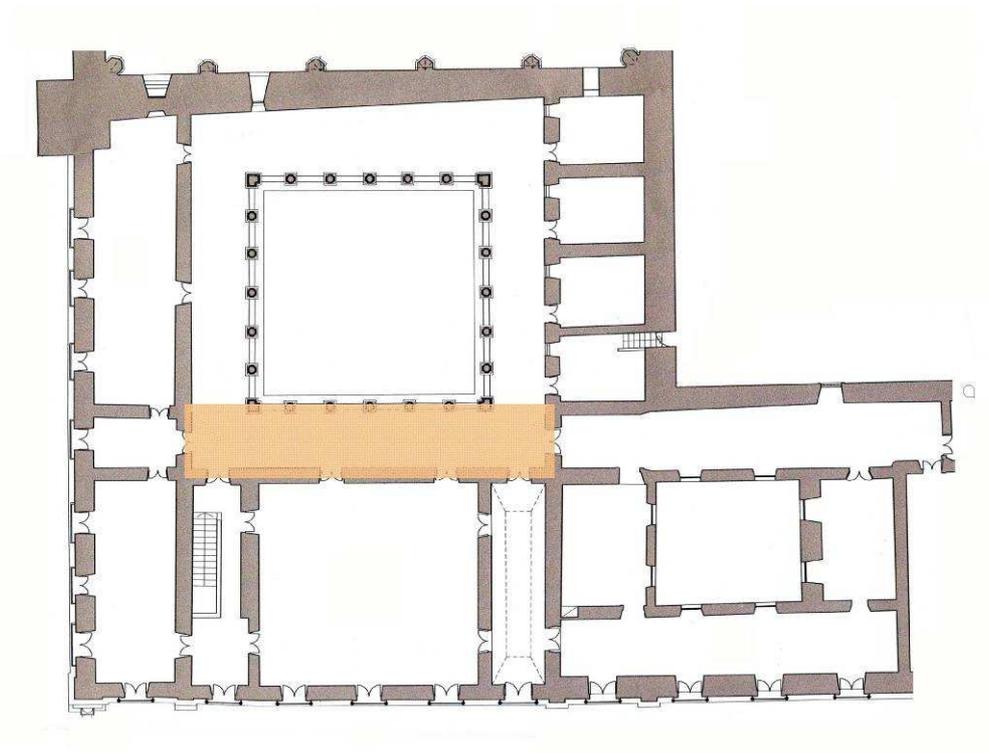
Localização da galeria Poente na planta do piso superior do levantamento de 2003.
